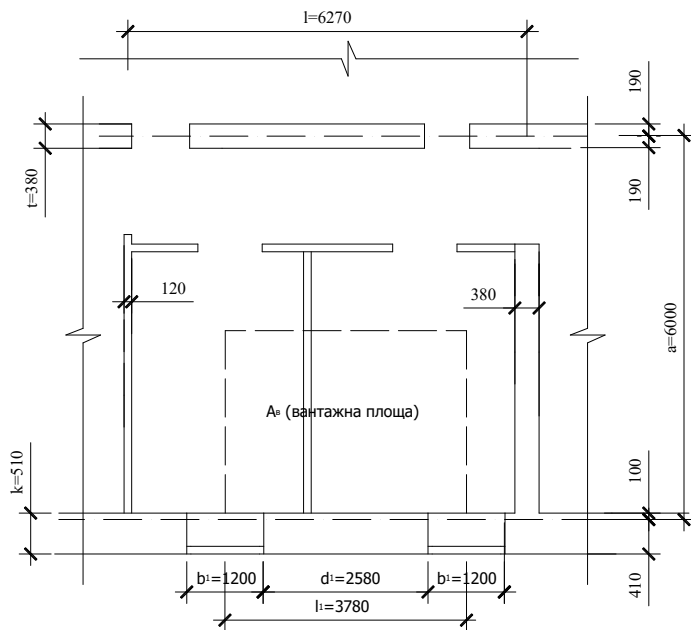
Фрагмент плану першого поверху будівлі
